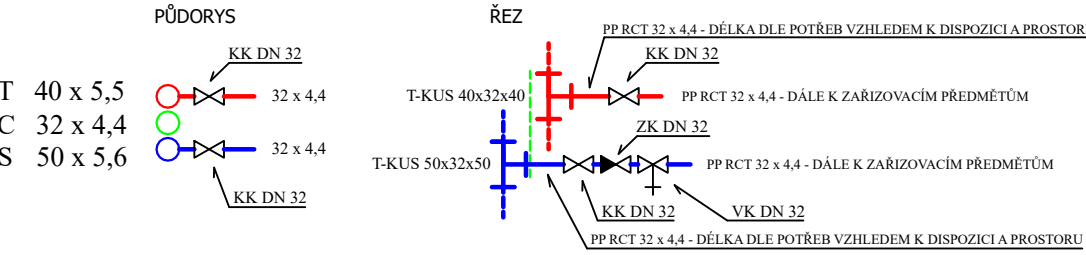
NÁPOJENÍ PŘIPOJOVACÍHO POTRUBÍ
